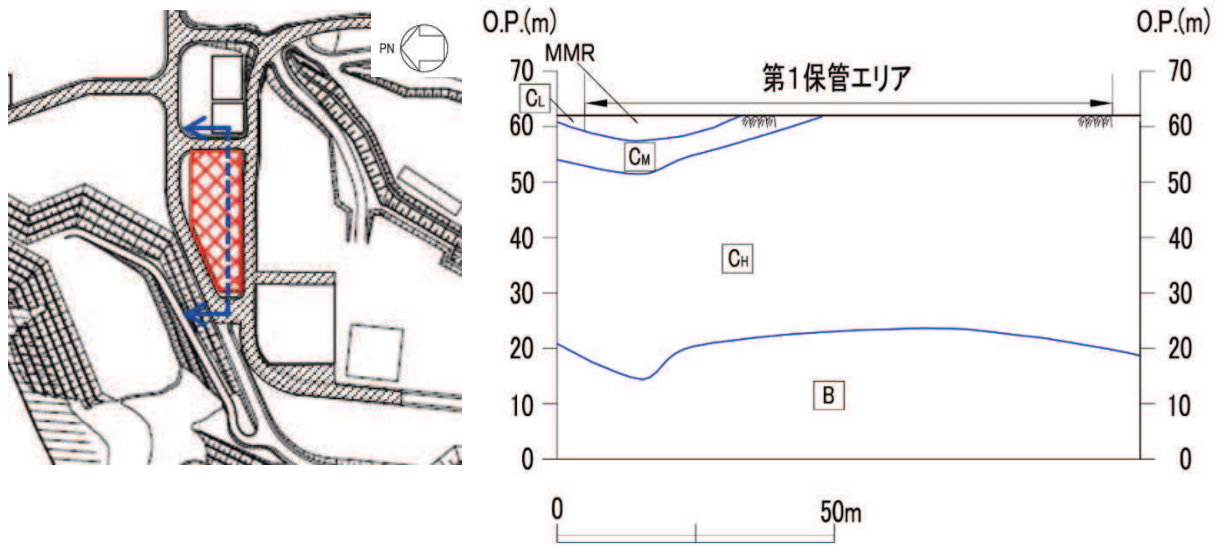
第1保管エリアの平面図及び地質断面図
